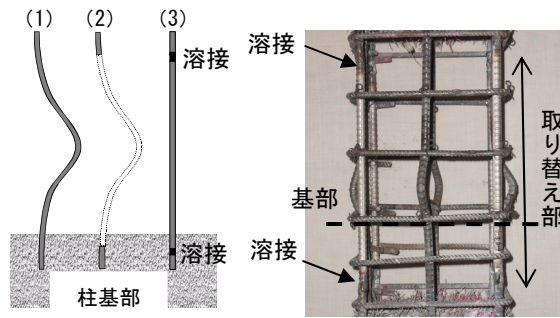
軸方向鉄筋の補修法 写真-2 鉄筋の部分取り替え
